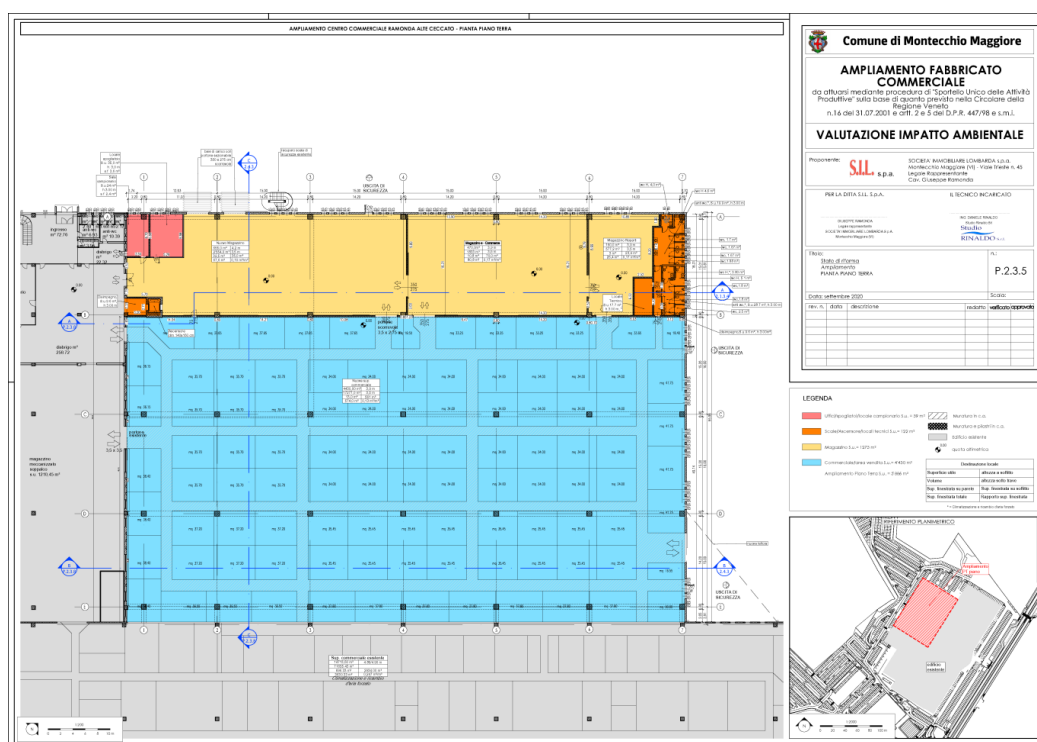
Edificio Ampliamento, Stato di riforma, Pianta piano terra.
